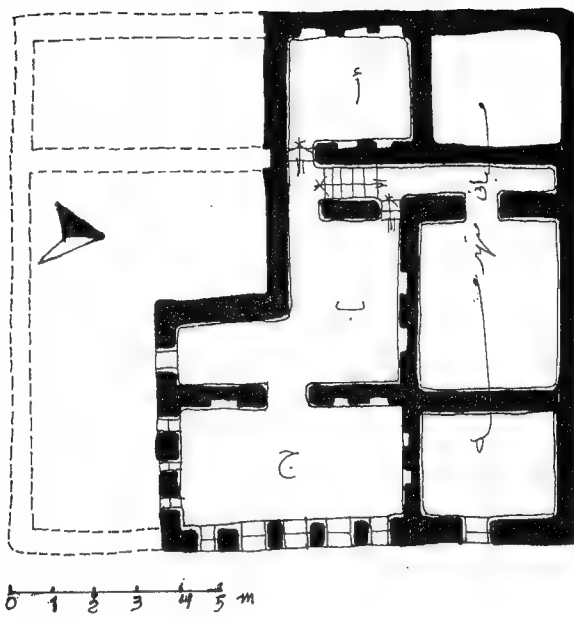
منزل ابو همام الدور الثاني - مسقط أفقى
